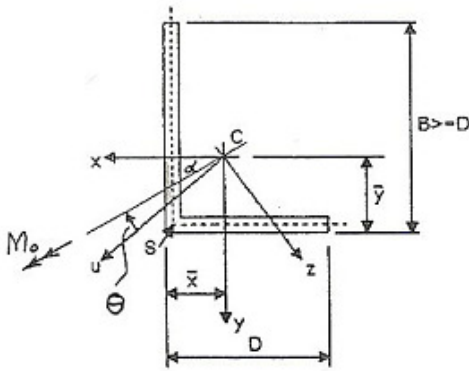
Eixos da seção transversal de cantoneira simples [17].
